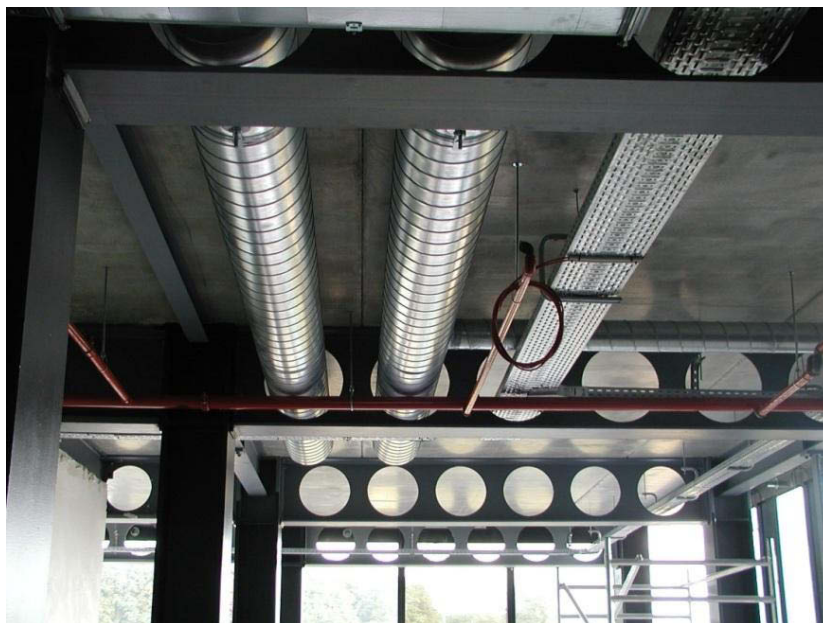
Exemple de plancher avec intégration de conduits au travers des ouvertures des poutres cellulaires [DUR, 09]
